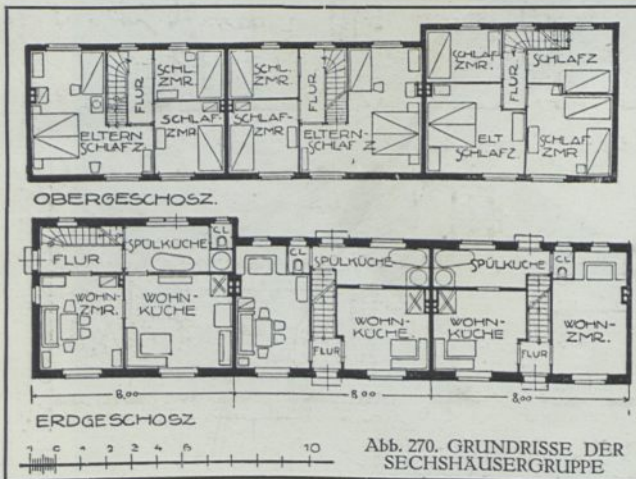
GRUNDRISSSE DER SECHSHAUSERGRUPPE
